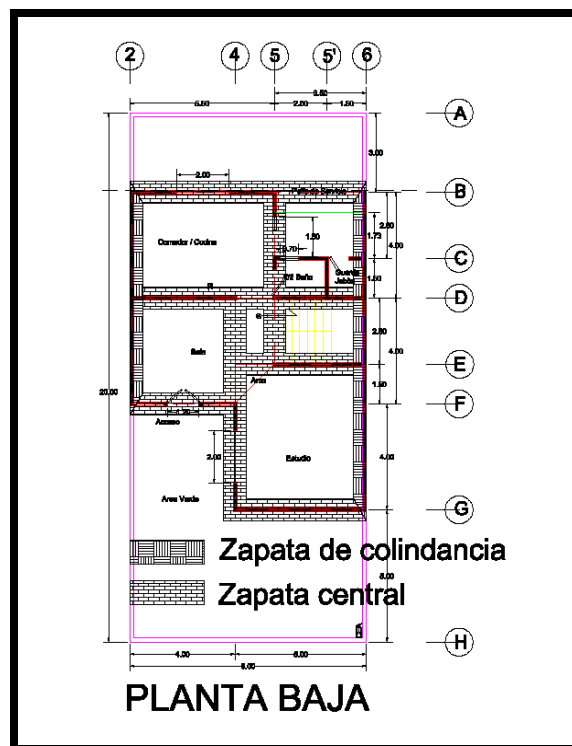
Planta donde se diseñaran las cimentaciones.
